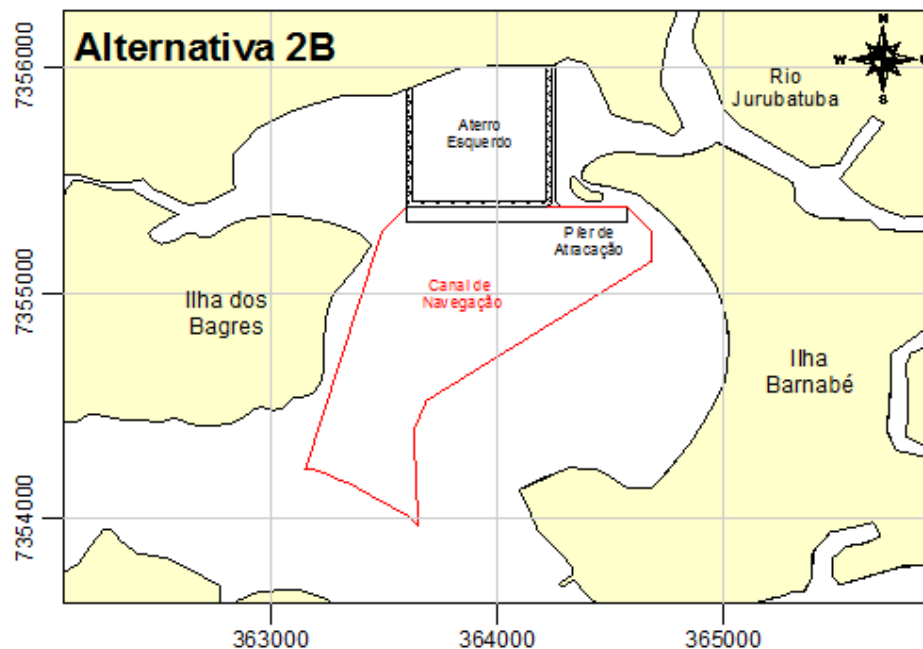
14: Layout do canal de navegação, estruturas e aterro parcial presente na alternativa 2B.
